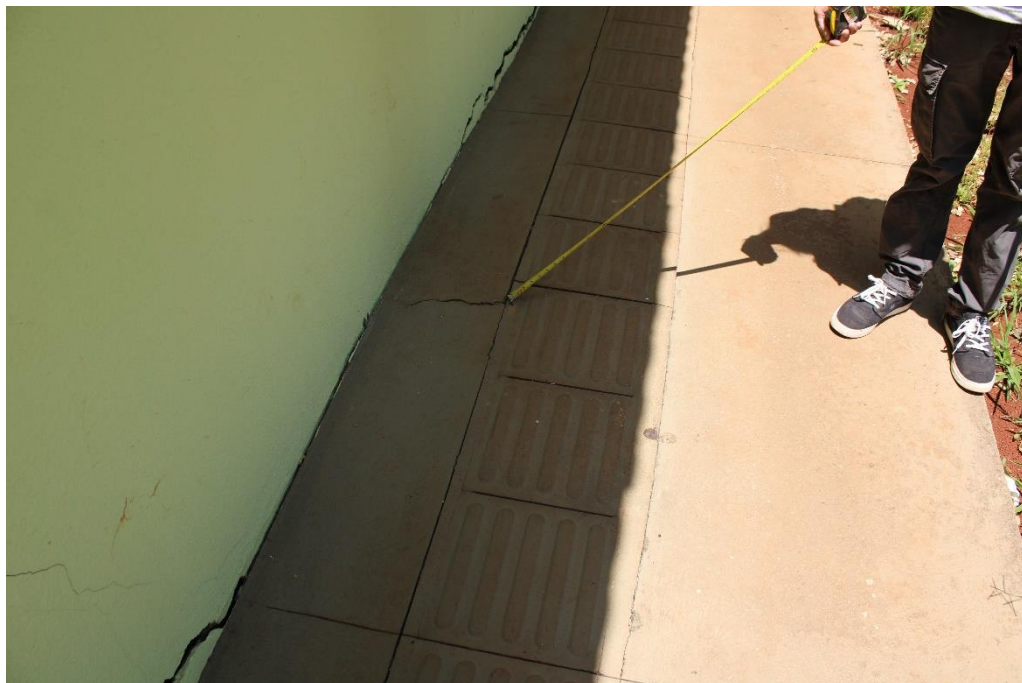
Vista parcial da Fachada Frontal, destacando trinca em calçamento externo em concreto desempenado.
